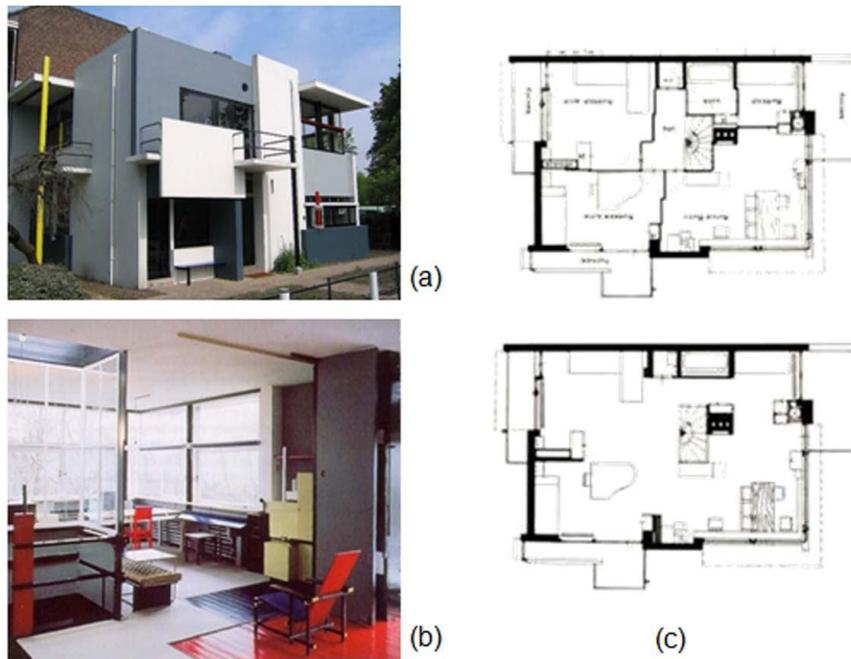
Gerrit Thomas Rietveld, casa Schröder, Utrecht, (1923-1924): (a) Vista exterior, (b) Detalle interior; (c) Plantas arquitectónicas, baja y alta.
